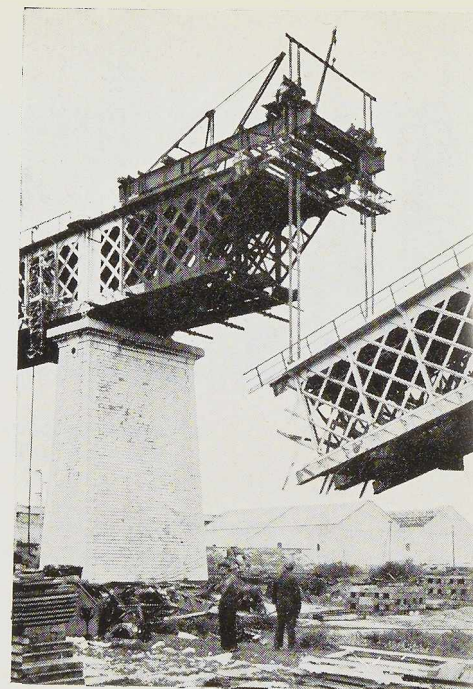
Dispositif de relevage de la travée d'accès de 51 mètres.
